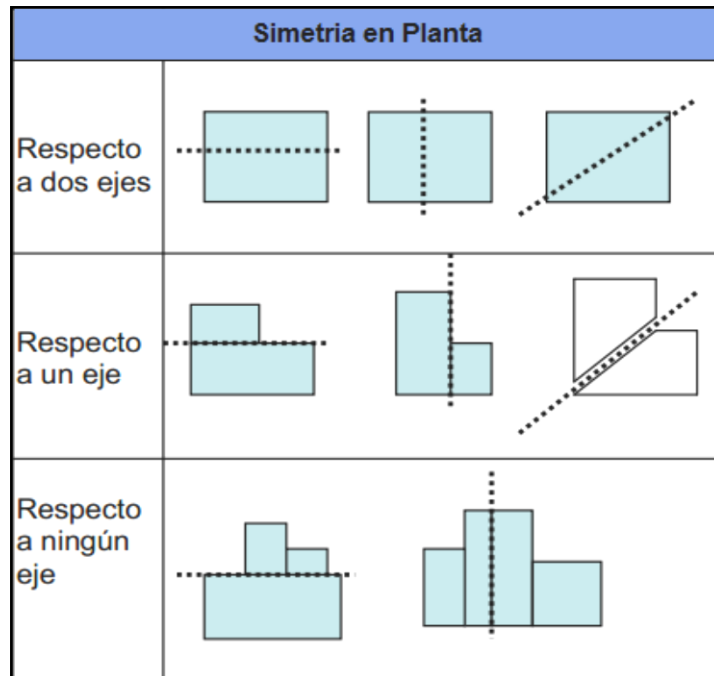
18. Simetrías en planta respecto de los ejes. Fuente: propia
